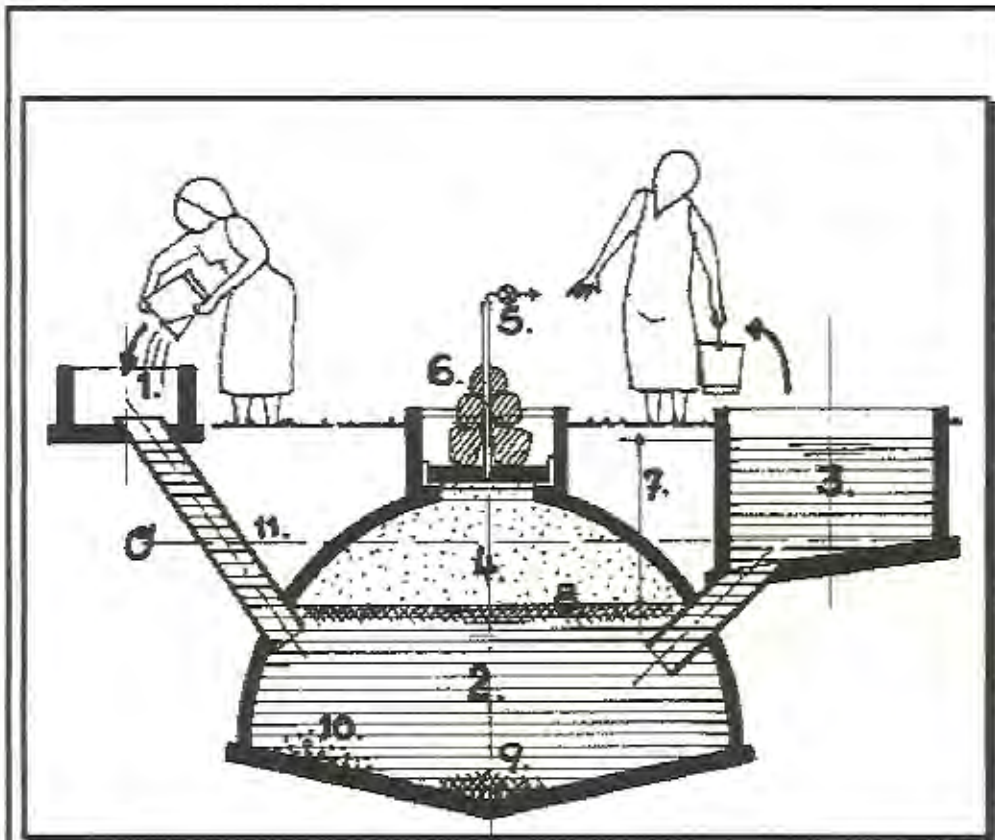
PLANTA CON CUPULA FIJA Y CON DEPOSITO DE GAS SEPARADO. FUENTE: LA PLANTA DE BIOGAS. LUDWIG SASSE.
